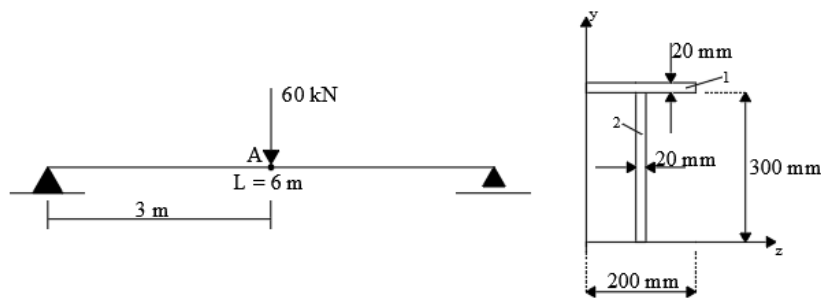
Viga biapoiada, submetida a carregamento pontual e com seção transversal em I
